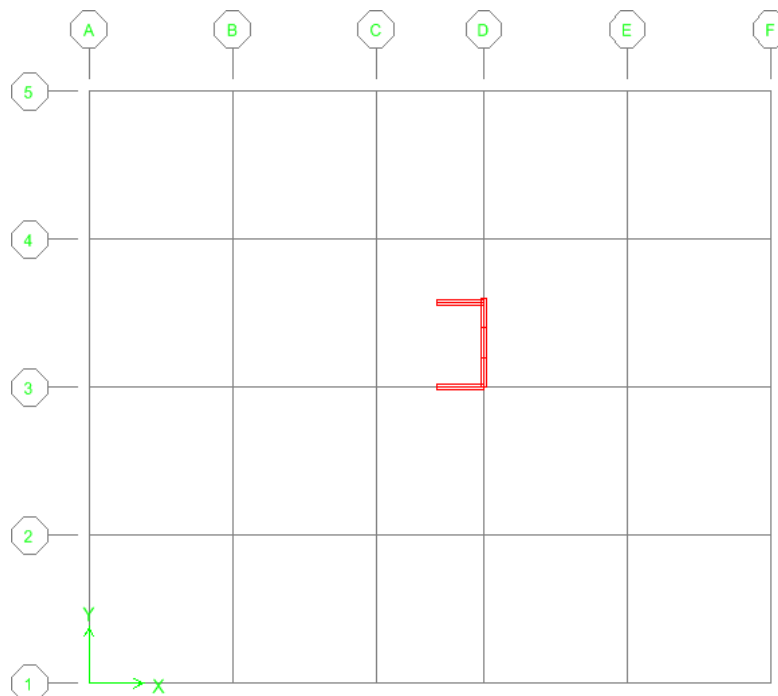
Vue en plan de la dalle d'ascenseur
